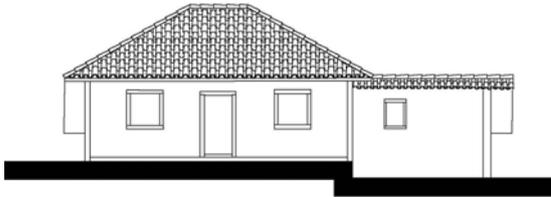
Fachada Sudoeste (Acervo PROAU/FAU/UnB).
